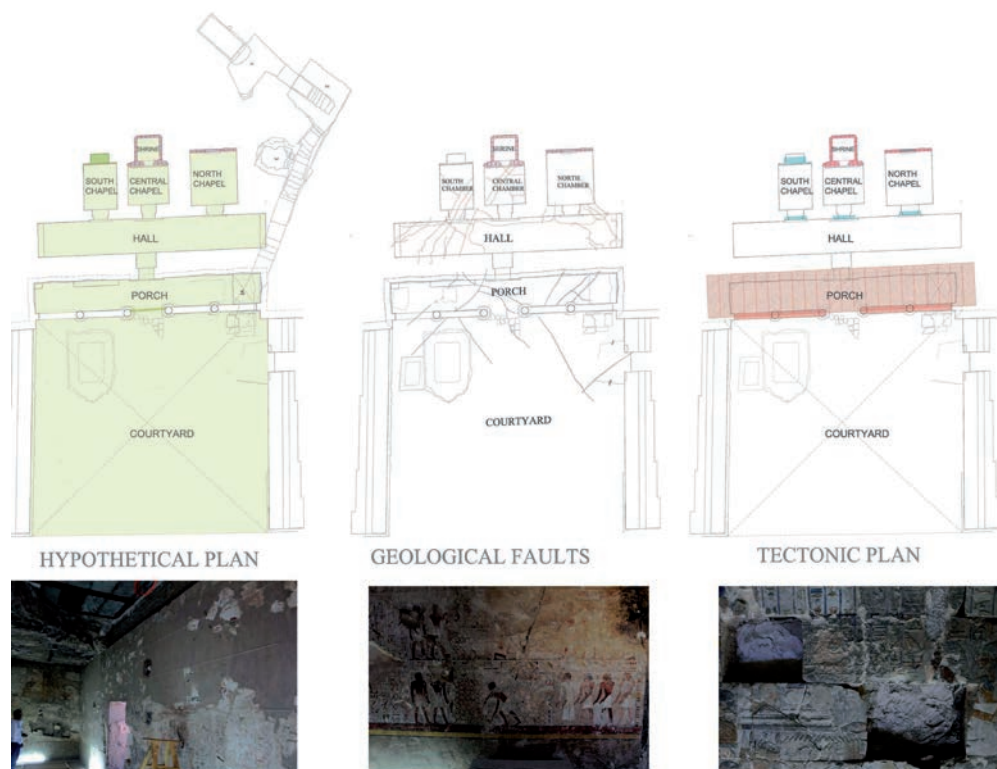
Comparativa de la planta arquitectónica de la TT39. De izquierda a derecha: Planta original hipotética, planta con las fallas geológicas diagonales a los muros y planta tectónica en la cual se señalan las zonas donde la tumba se construyó con piezas de cantería prefabricadas.
